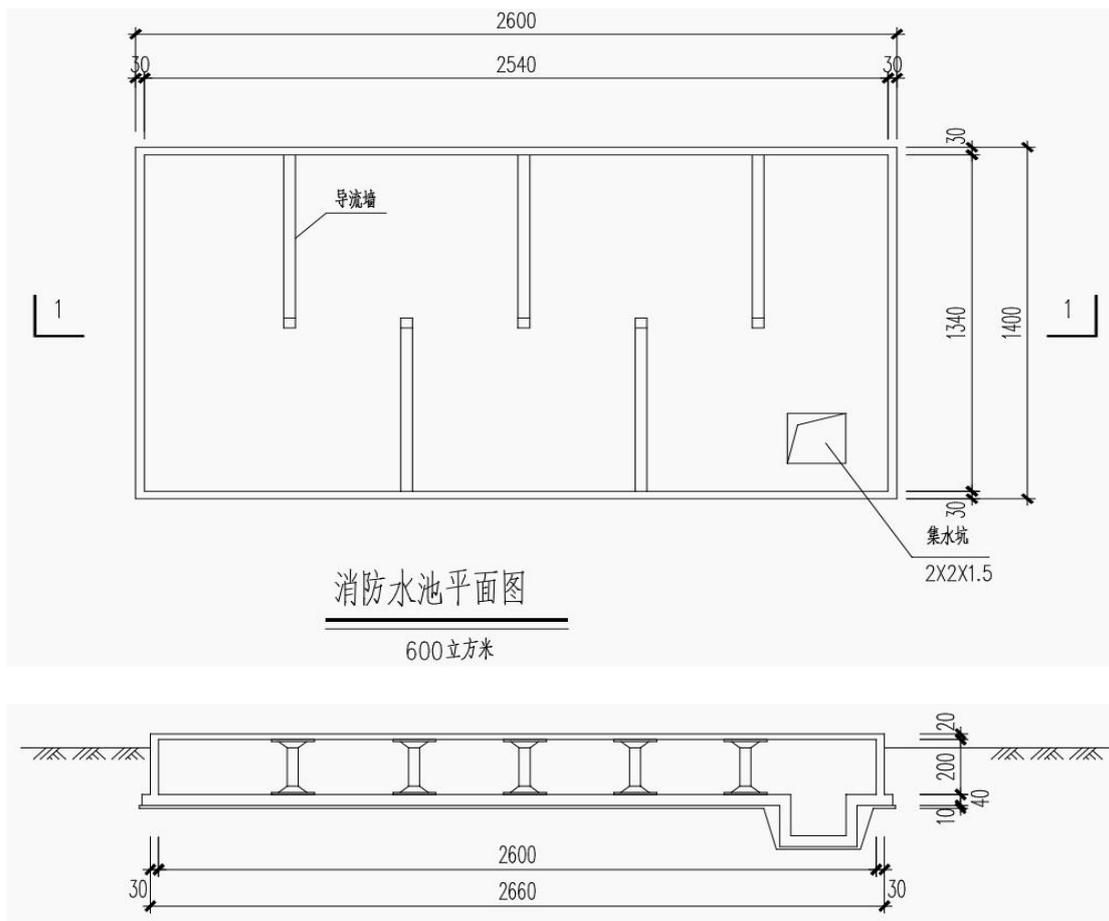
茂县 2#隧道消防水池平面布置图及剖面图
